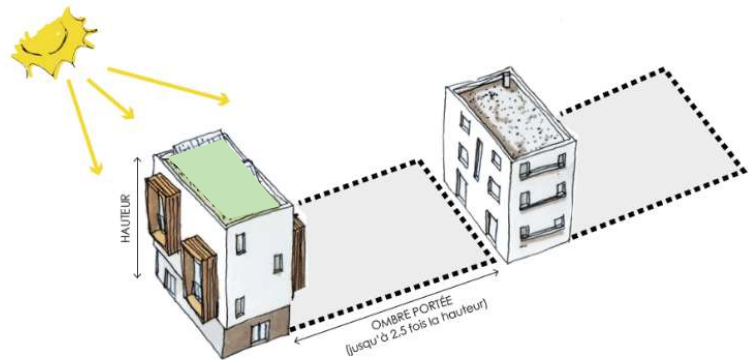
Illustration de l'ombre portée en fonction de la hauteur d'un bâtiment.
